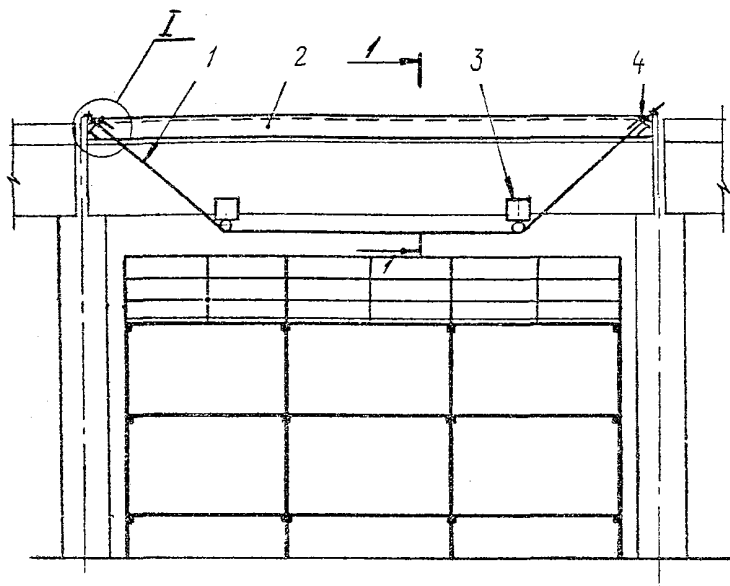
,12. Схема усиления подкрановых балок шпренгельной затяжкой с креплением к обойме полки:
